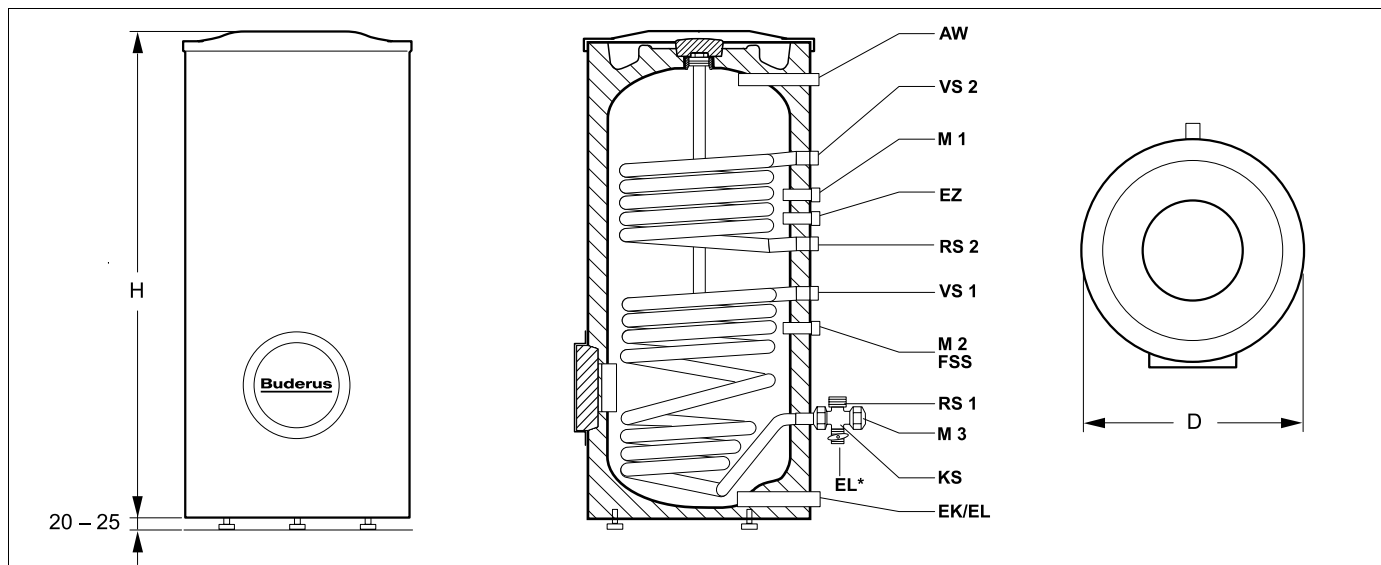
Dimensioni e attacchi (dimensioni in mm)
